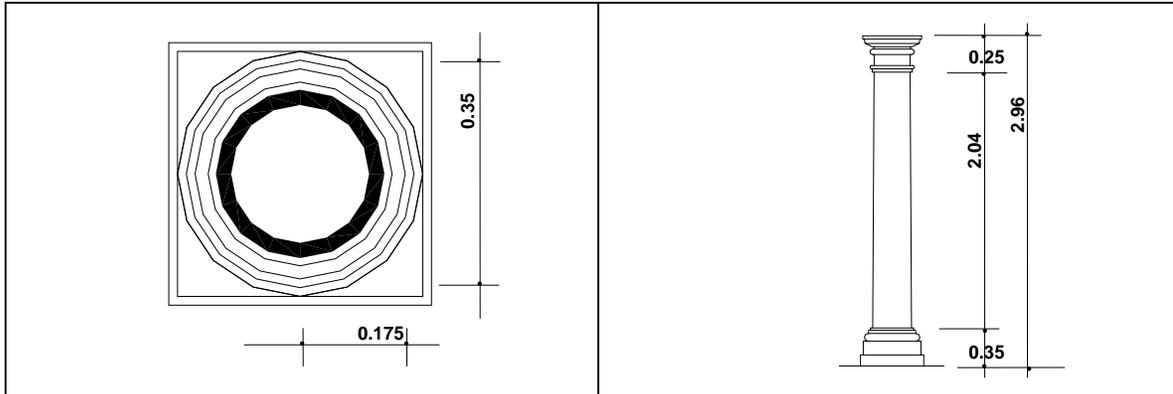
Diámetro y radio a la altura del imoscapo de columnas en planta alta, Palacio Episcopal.
